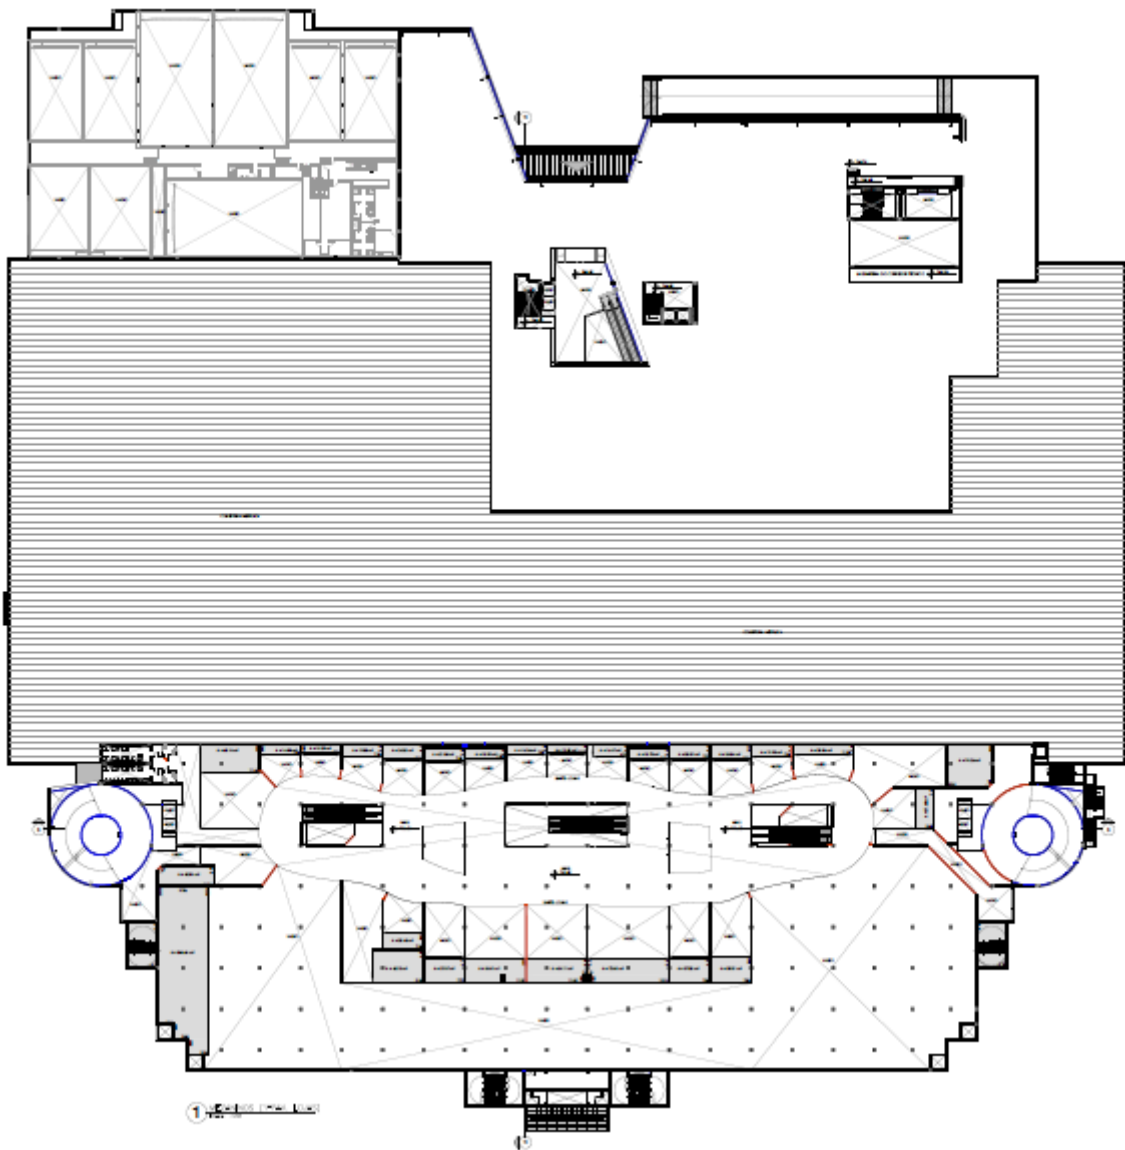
Planta Mezaninos (Primeiro Pavimento - Lojas). Fonte: Engexpor.
